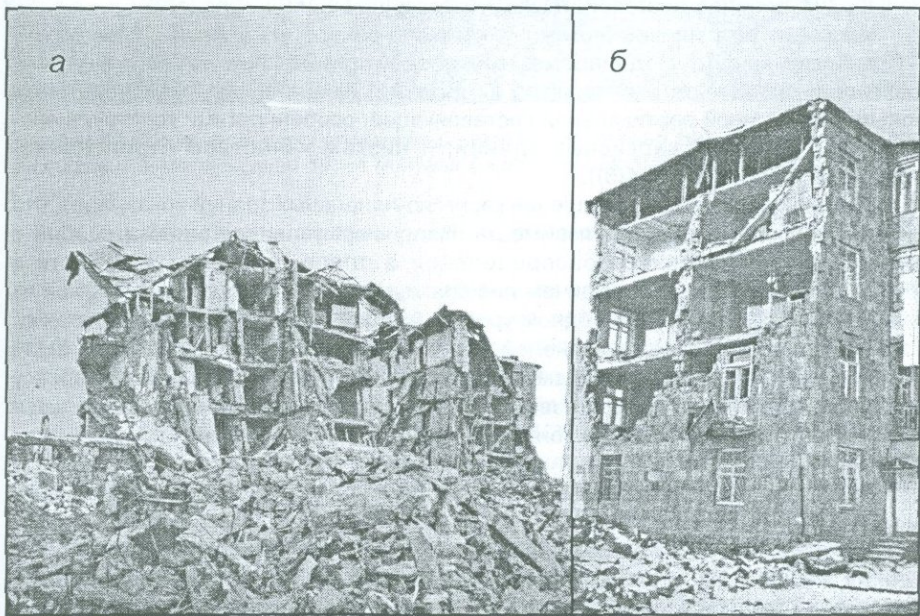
(4) Типичные разрушения зданий с каменными стенами во время Спитакского землетрясения 1988г. (Armenia Earthquake Reconnaissance Report, 1989): Разрушенное многоэтажное здание с каменными стенами в г. Спитаке (а) и в г. Ленинакане (б).
